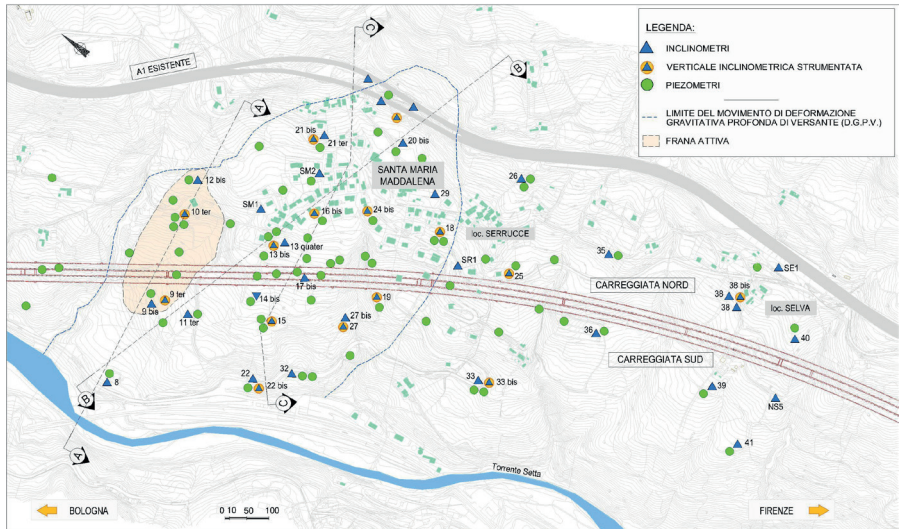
Planimetria dell'area oggetto di monitoraggio.
